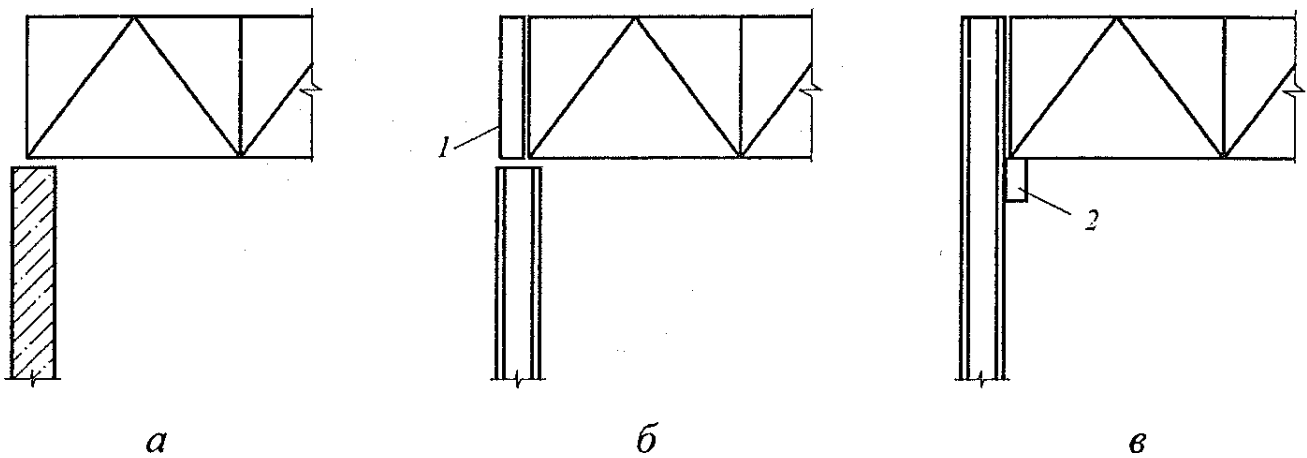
Обпирання ферм на несучі вертикальні опори: *а* - на цегляні стіни та залізобетонні колони; *б-в* - на металеві колони; *1* - надколонник; *2* - опорний столик
